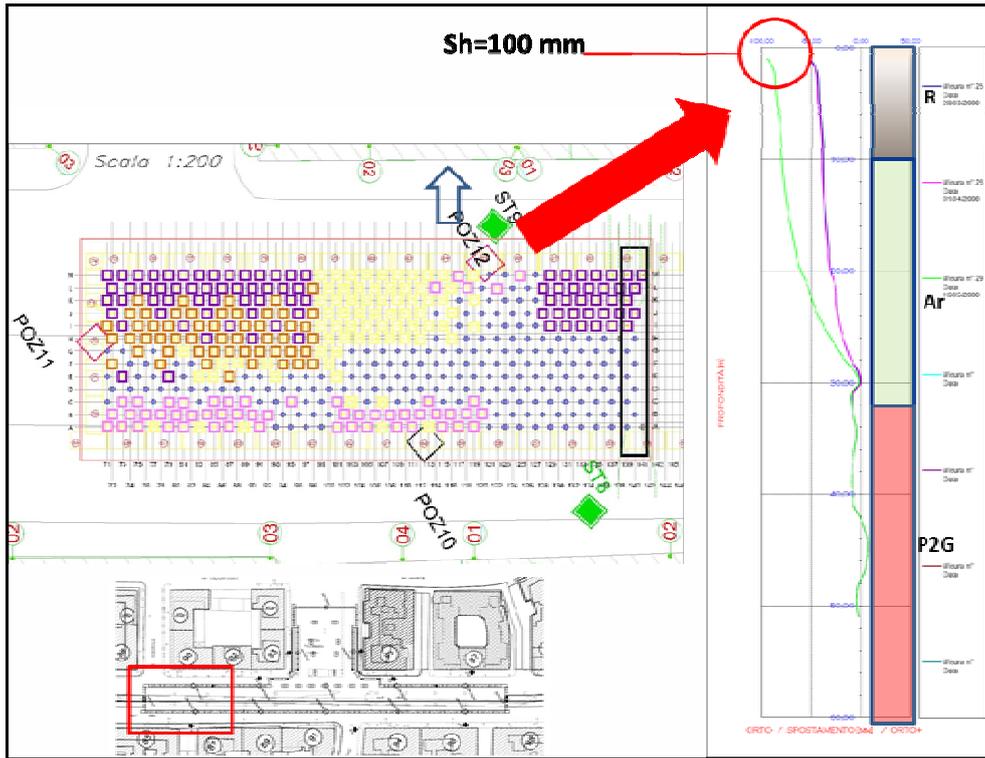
Posizione e Deformata registrata del tubo inclinometrico installato nel diaframma POZ12 durante la realizzazione delle colonne jet-grouting del tampone di fondo; schema litologia: Riporto; Alluvioni recenti; P2G: Paleotevere2 Ghiaie.
